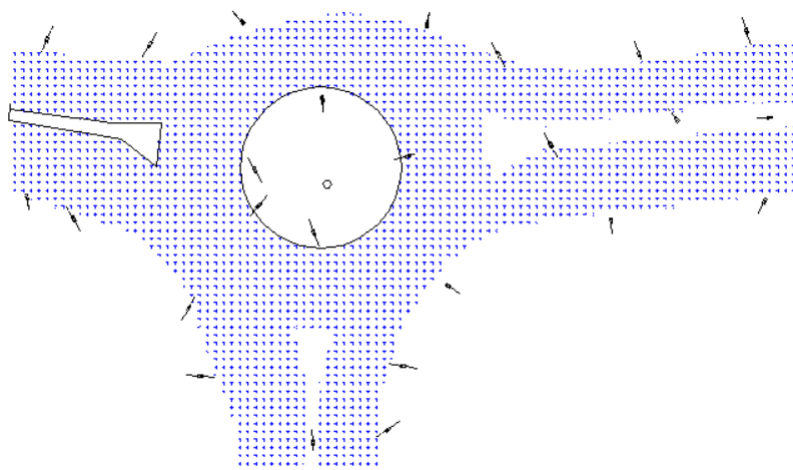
Planta da rotunda com a disposição das luminárias.
